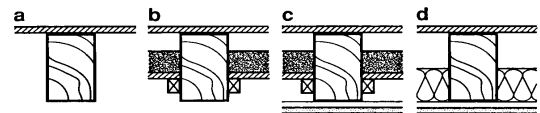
Ausführungsvarianten von Holzbalkendecken (a) mit sichtbaren Balken; (b) mit teilweise sichtbaren Balken und mit Zwischenboden (Blindboden); (c) mit Zwischenboden und unterseitiger Verkleidung (Altbaukonstruktionen); (d) mit unterseitiger Verkleidung und Hohlraumdämpfung [FAS98]
